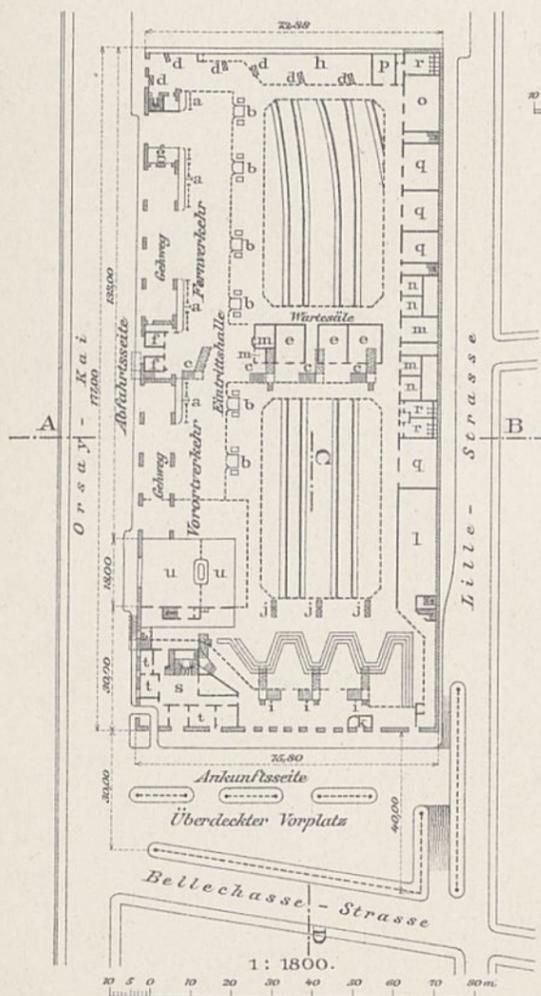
Grundriss des Empfangsgebäudes des Orsay-Bahnhofs.
